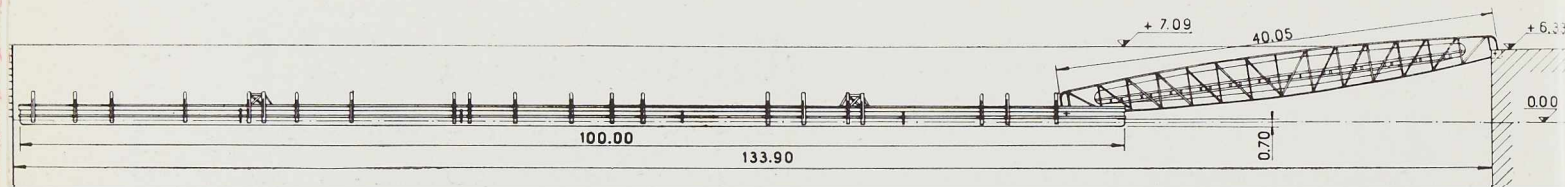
Plan général du ponton flottant avec son pont d'accès.
